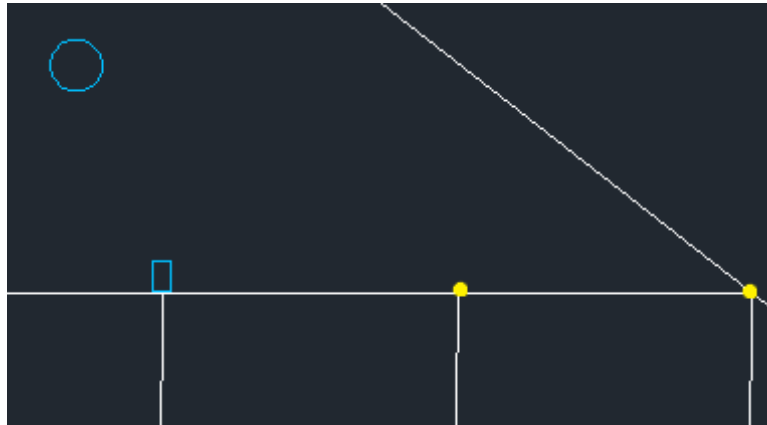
Plano iluminación plazas aisladas primera fila.
